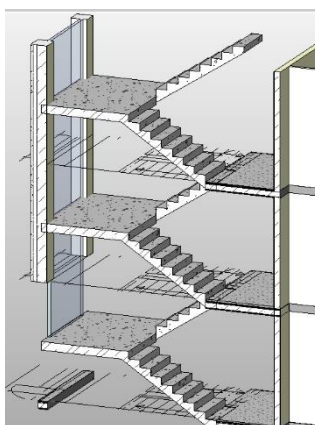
Příkazy pro připojení/odpojení schodiště k patřím
